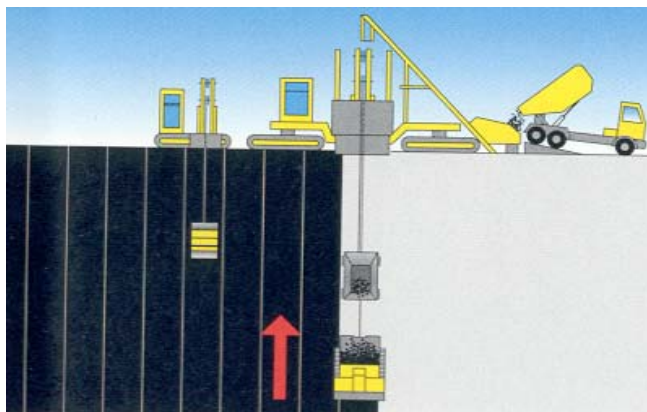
Esquema construtivo da face betuminosa utilizando pavimentadora vertical (Walo, 1997a).
